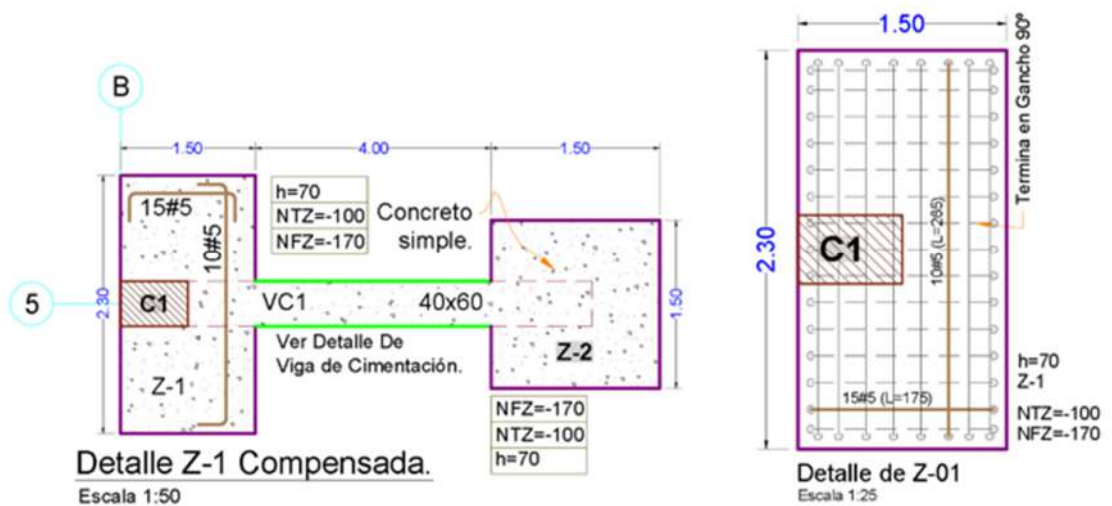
Propuesta Estructural de Cimentación en Cobertura
